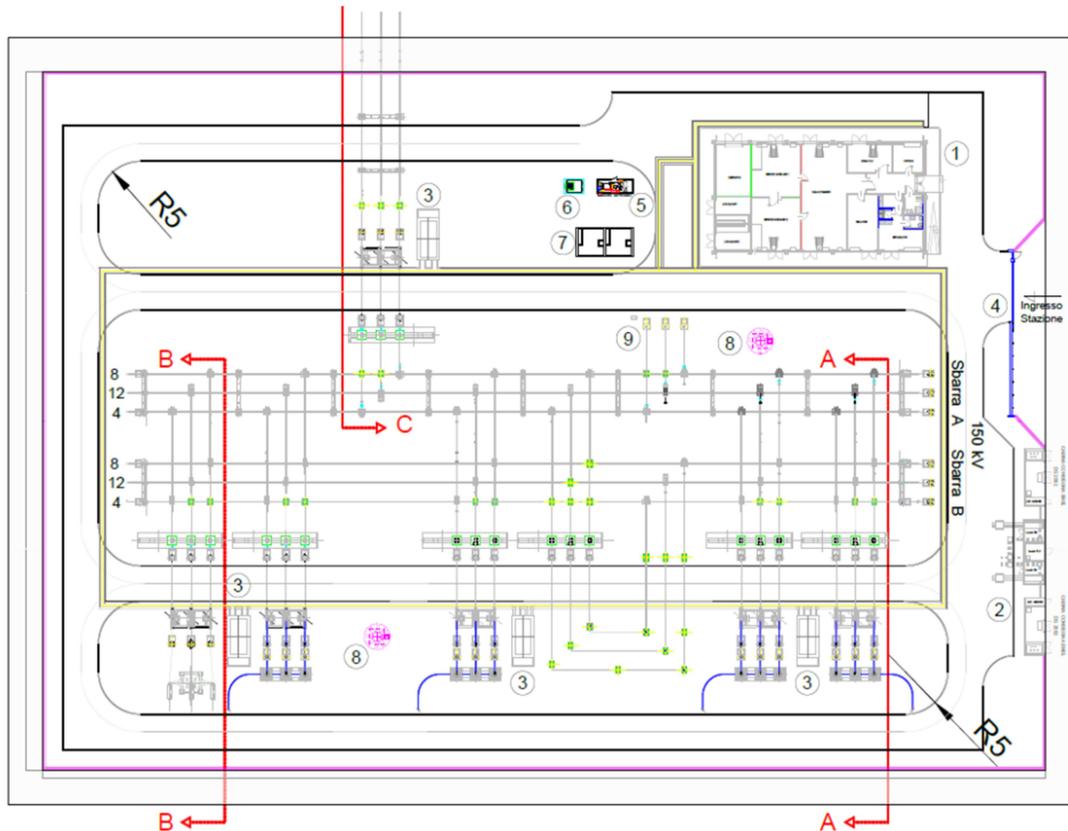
Pianta elettromeccanica della nuova stazione della RTN
